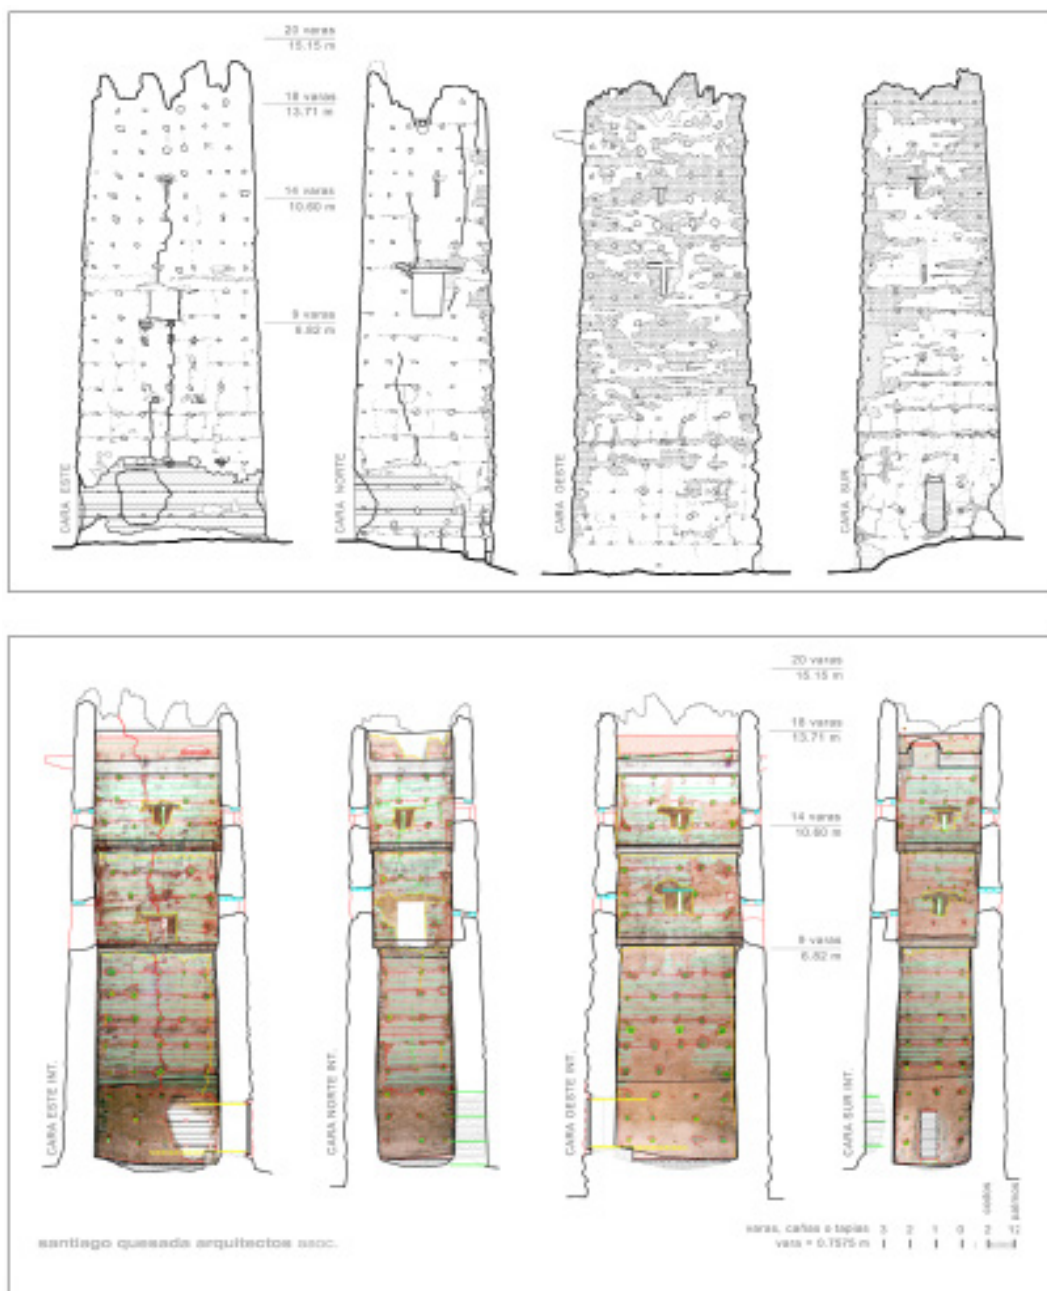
Alzados (arriba) y secciones (abajo) actuales de la torre Sur de Santa Catalina, con la propuesta de intervención.
